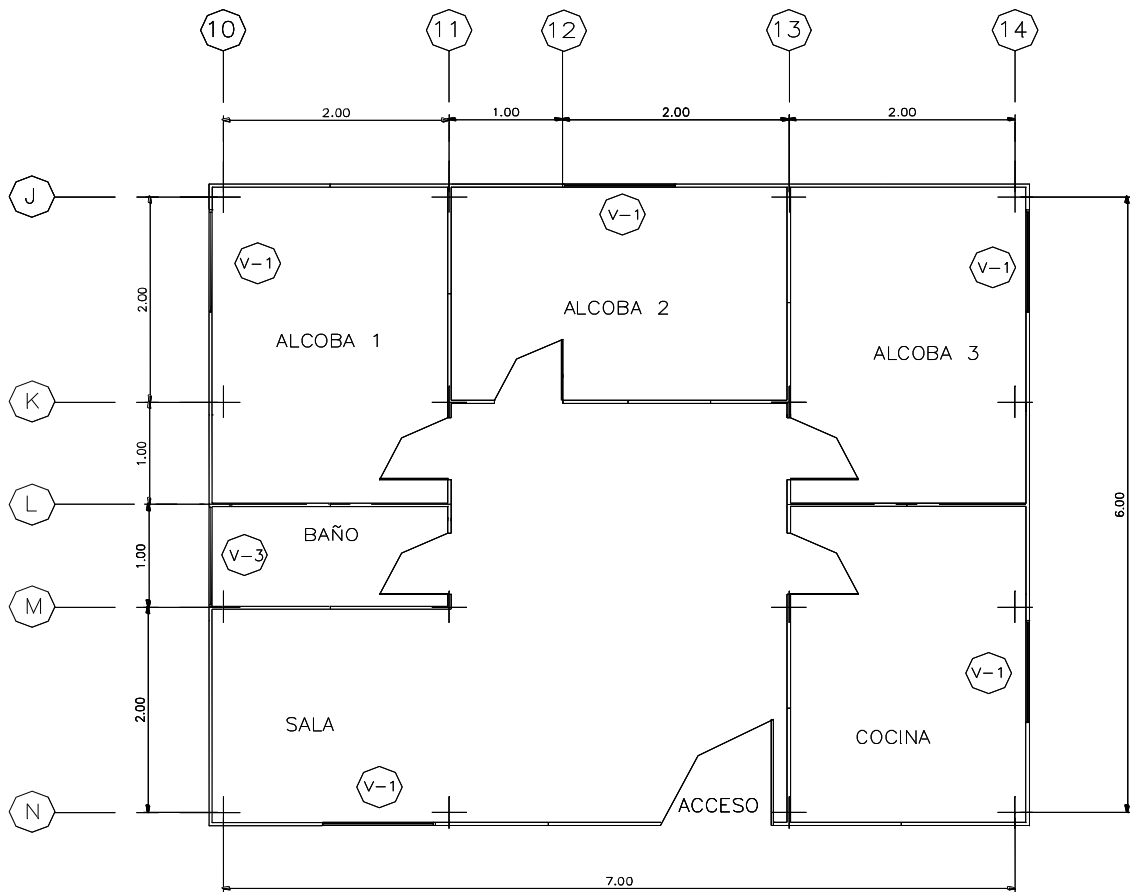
Planta arquitectónica primer piso [Bedoya 98]
